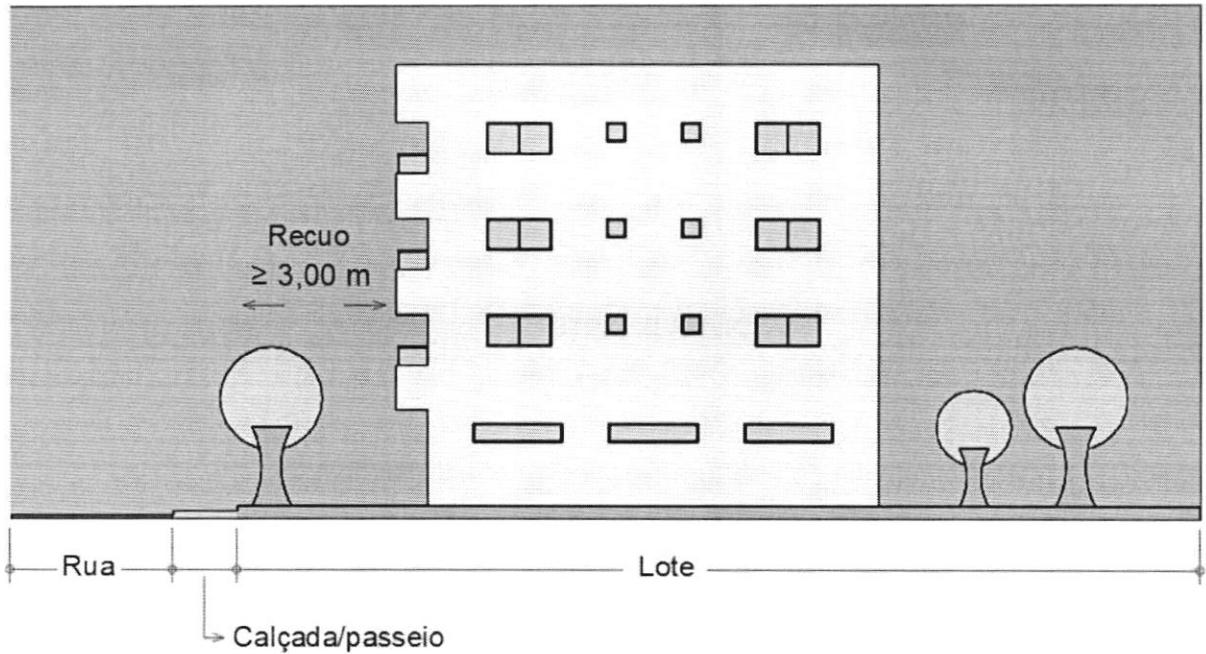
Recuo Frontal com projeção do pavimento Térreo
